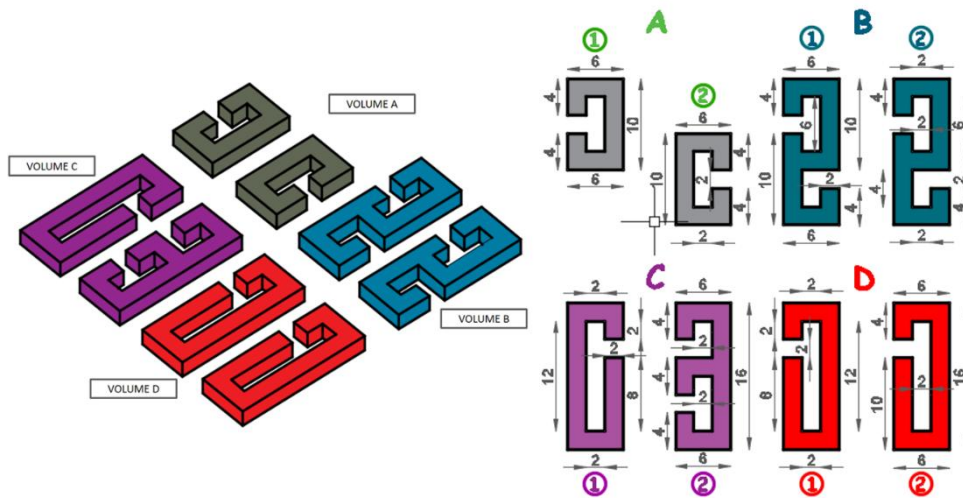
étape de forme et dimensionnement / source :Auteur
